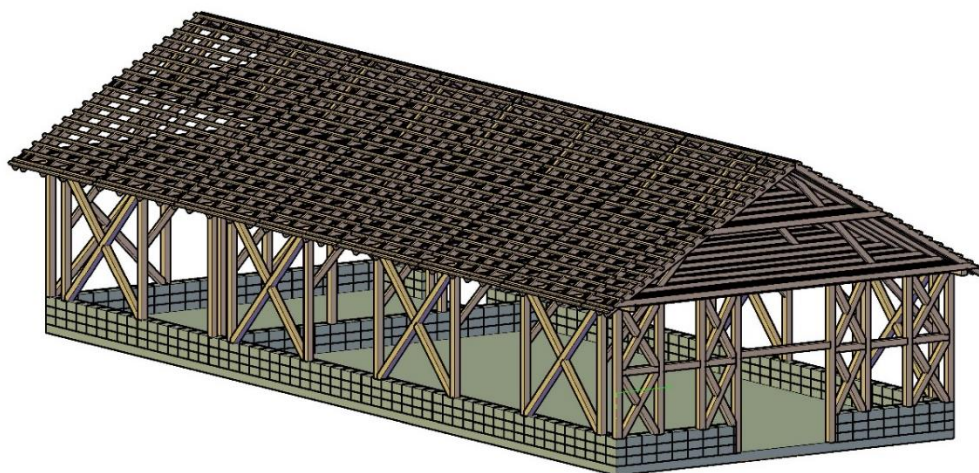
Sklad pro zemědělskou techniku (Wolf Systém 2017)
